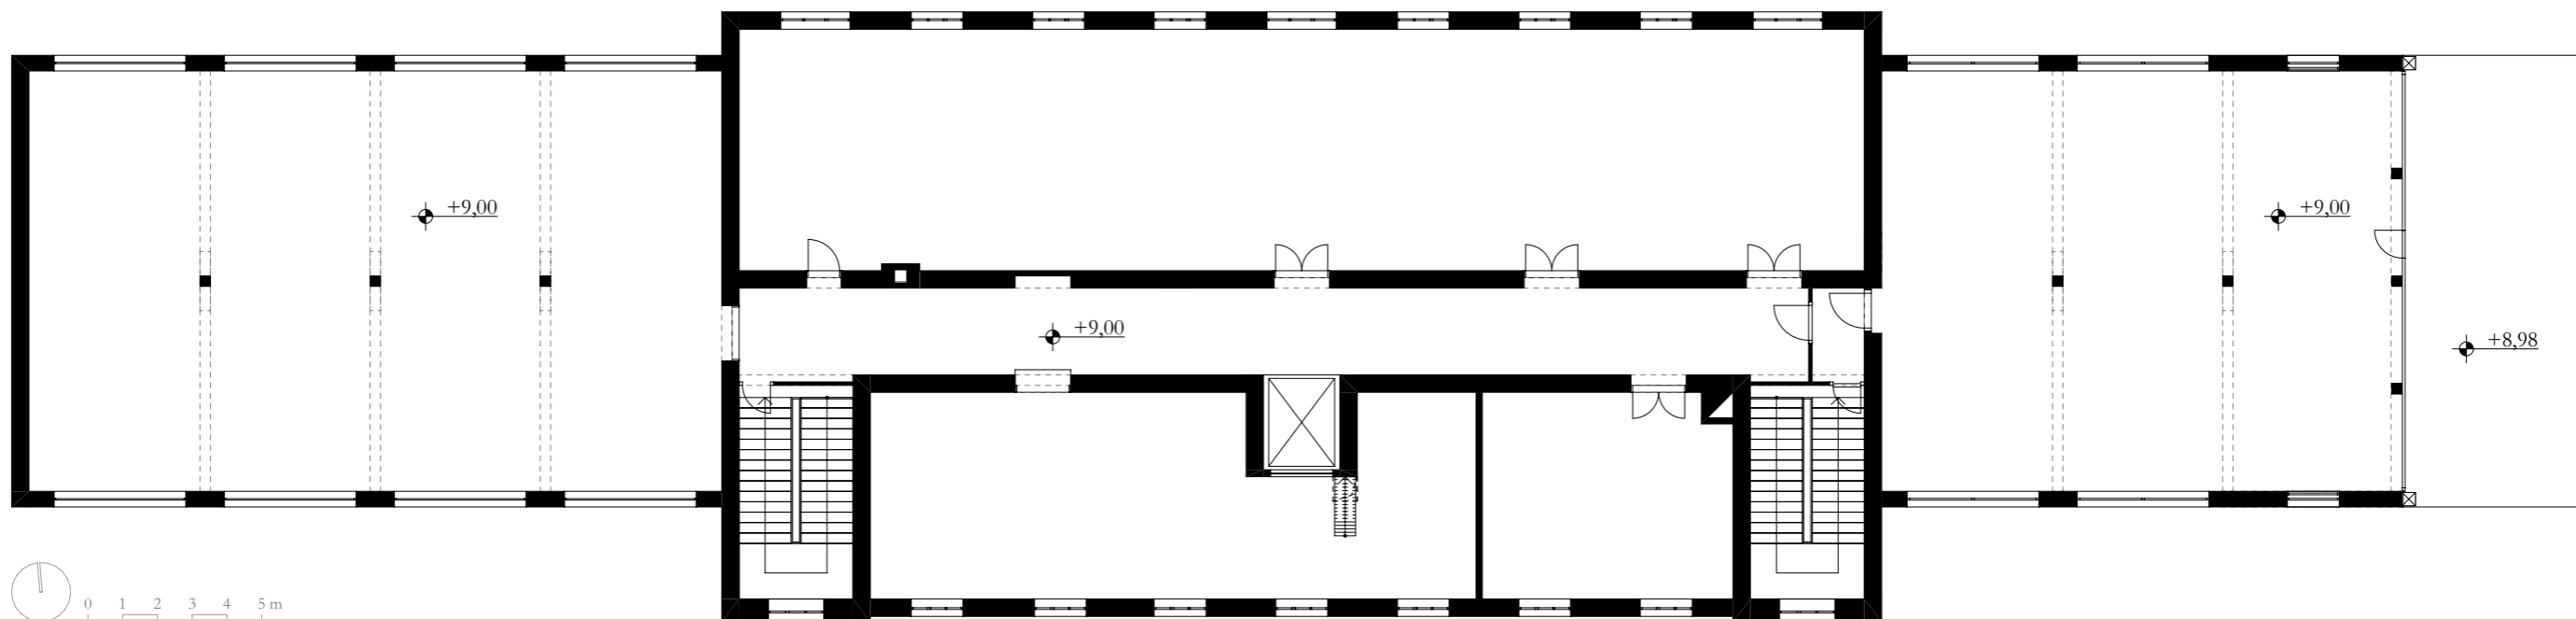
Grundriss Bestand Dachgeschoss M 1:200
